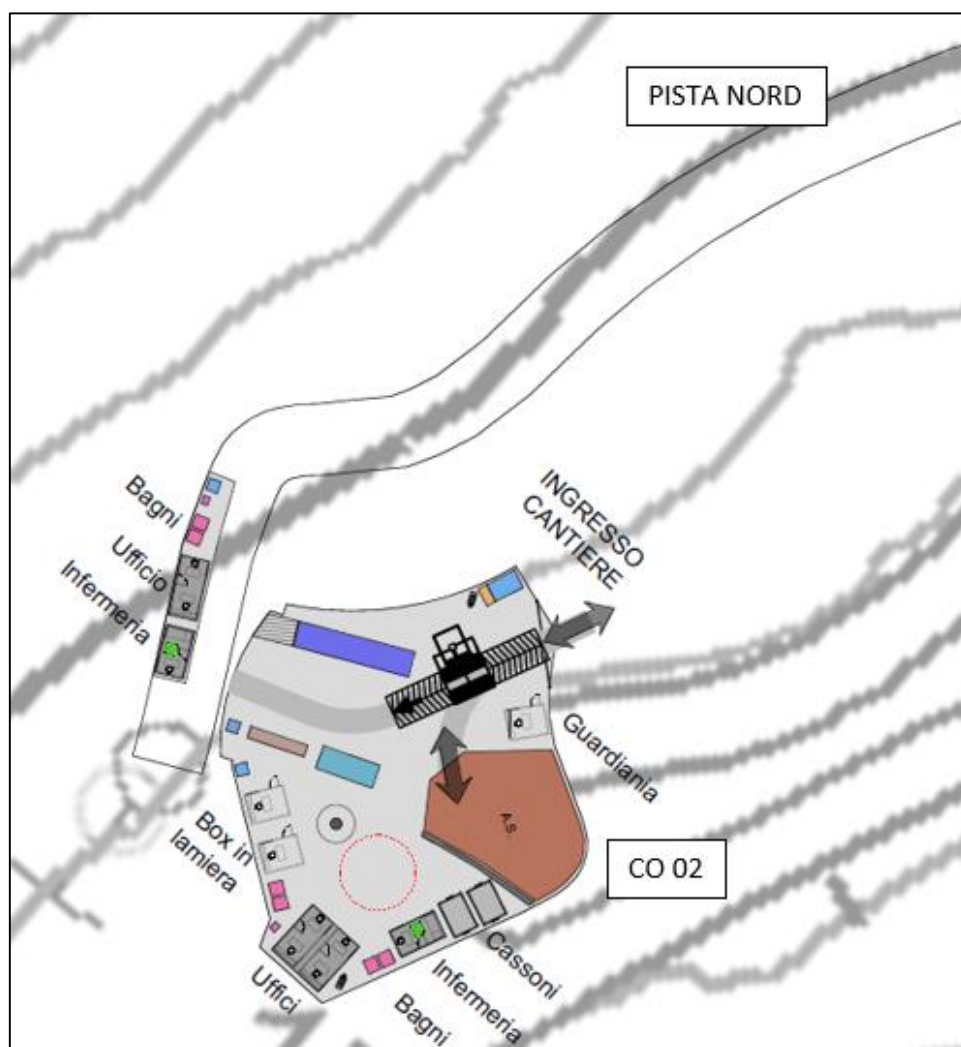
Layout cantiere operativo all'imbocco nord (CO 02).
